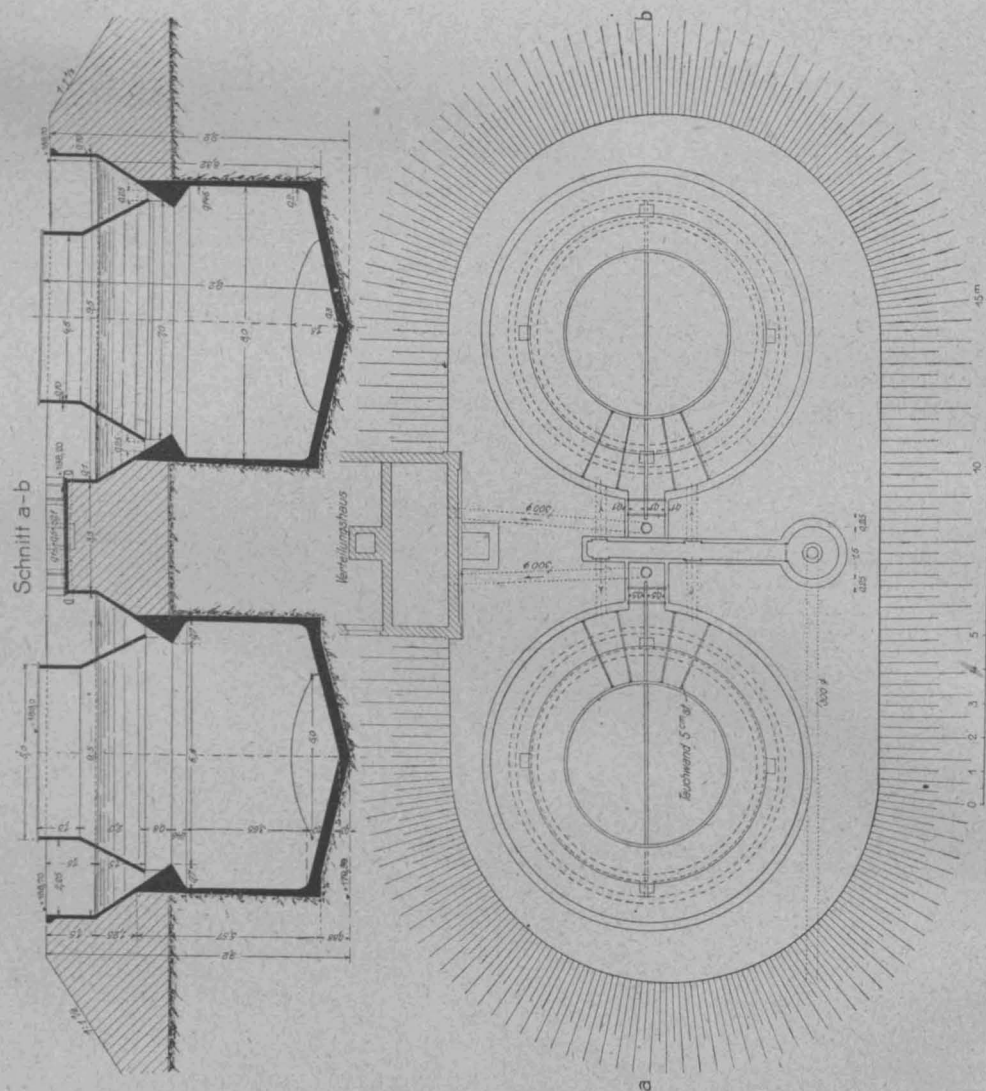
Gesamtübersicht der Kläranlage für die Stadt Jauer O.S. Entwurf Ziv.-Ing. Rosenquist in Breslau. Ausführung: „HUTA“, Hoch- und Tiefbau-A.-G. in Breslau.
